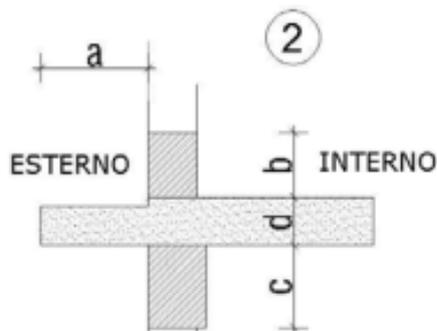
Fascia di separazione orizzontale - Soluzione 2
